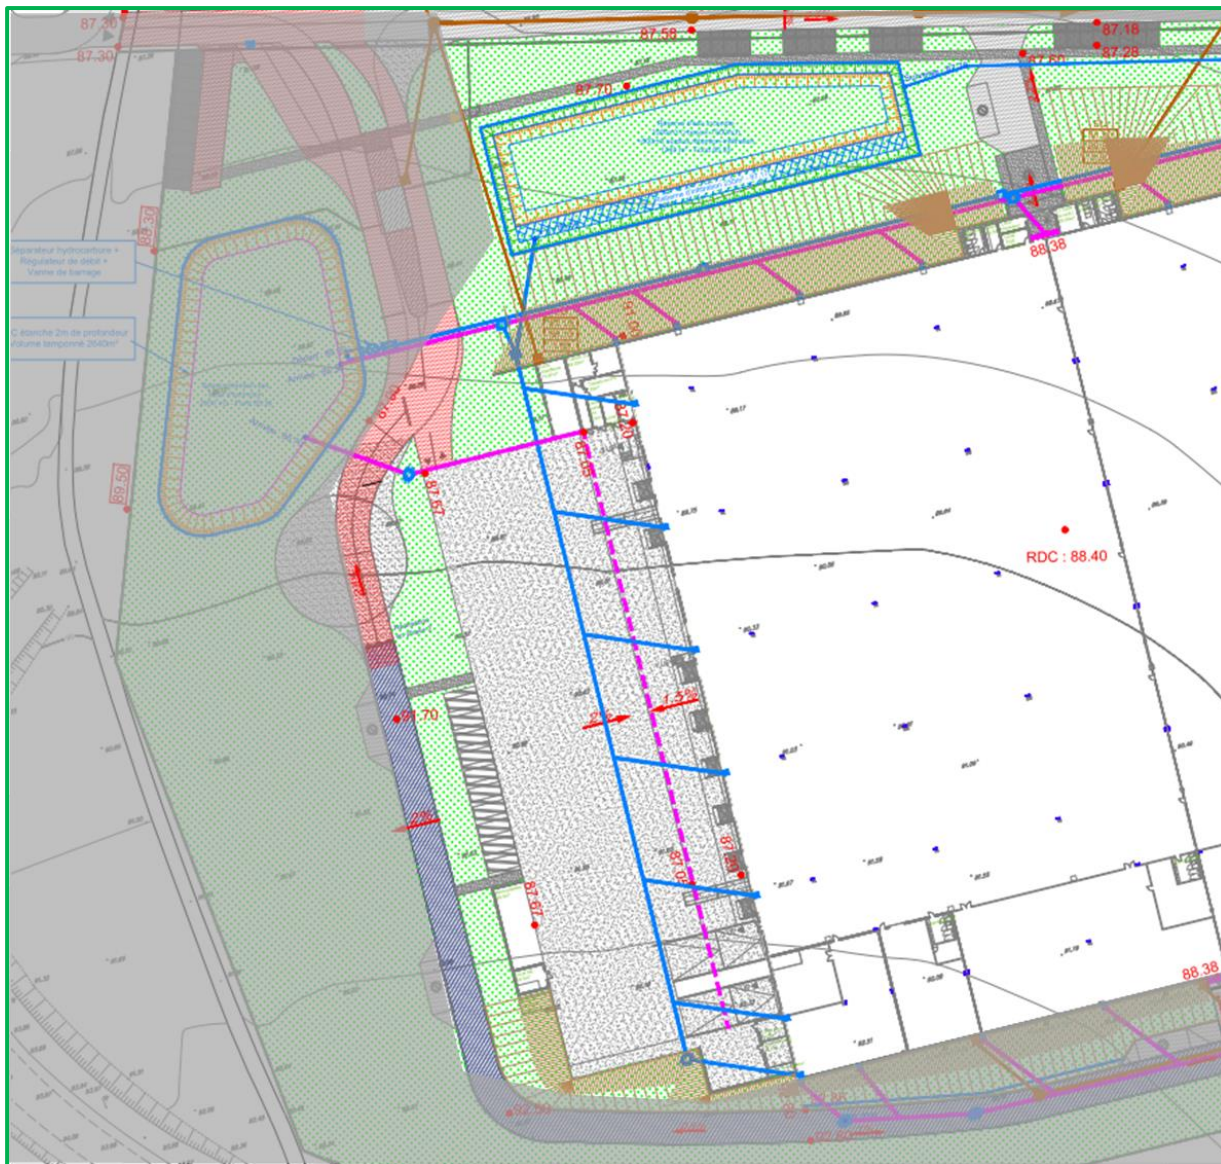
Gros Plan sur la gestion des eaux pluviales des toitures (1) (INFRA Services)
